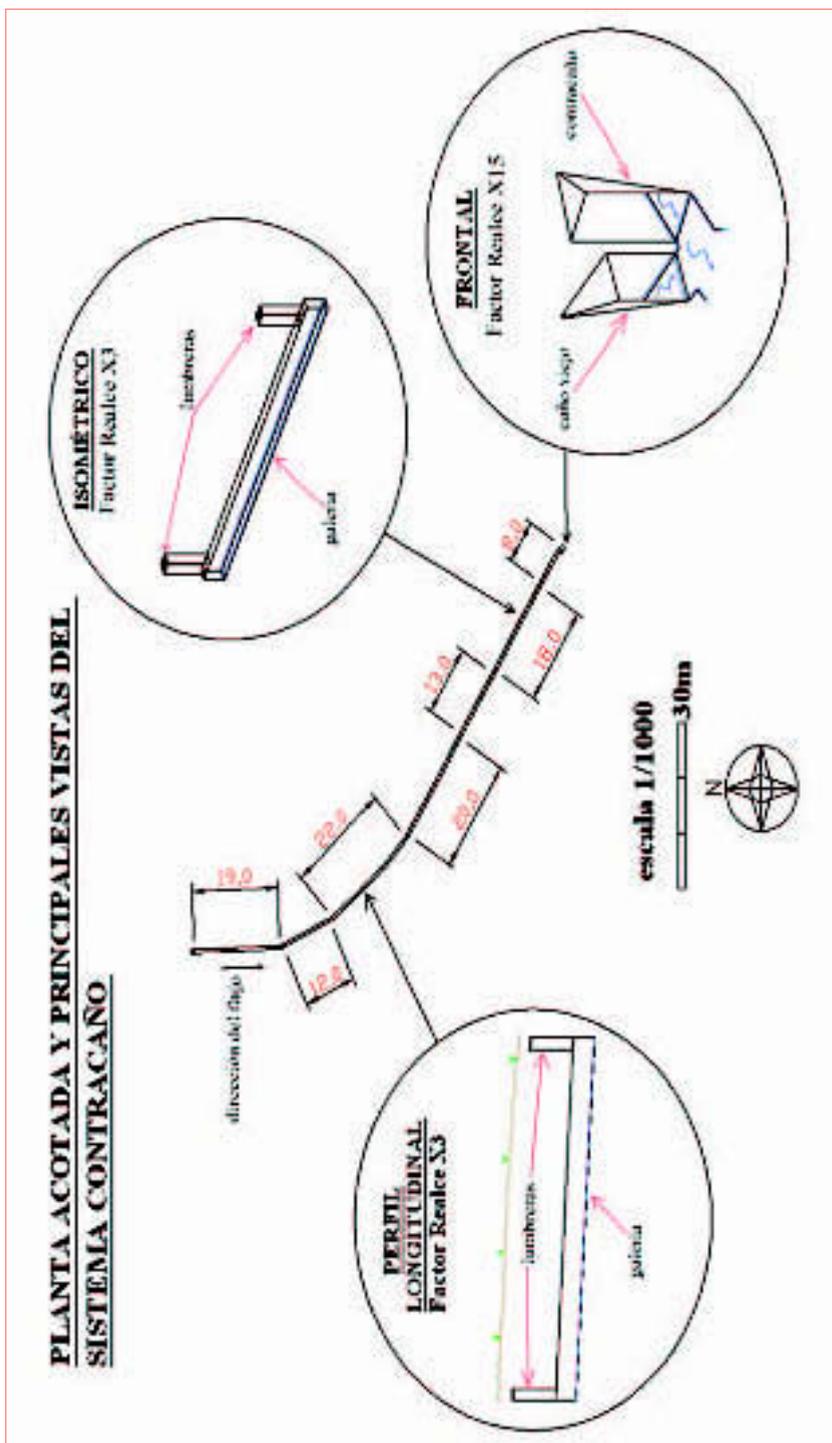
Planta acotada y principales vistas del sistema Contracaño.
